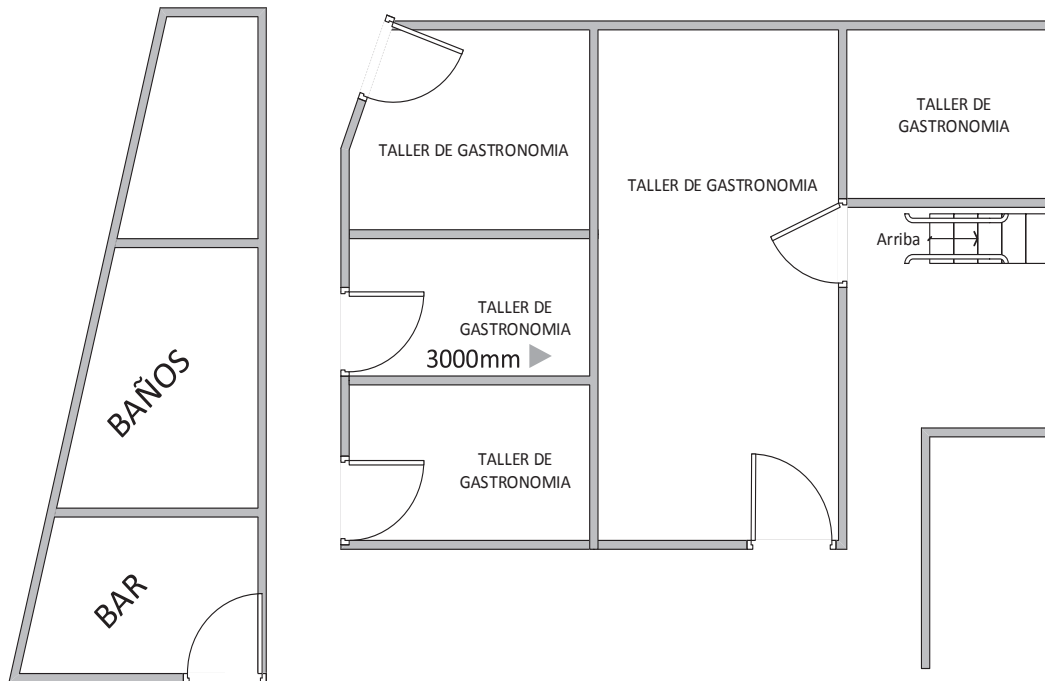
Distribución de las áreas Planta Baja ala occidental
